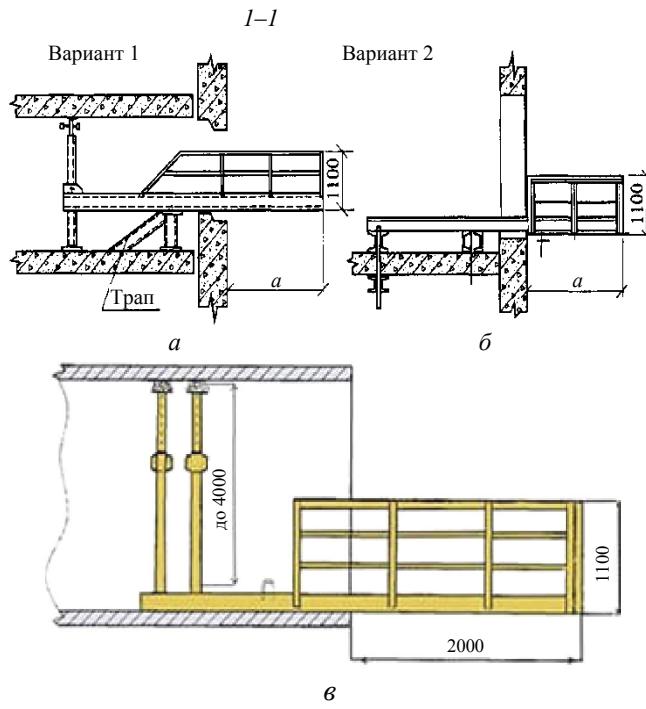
Схемы установки выносных грузоприемных площадок:
